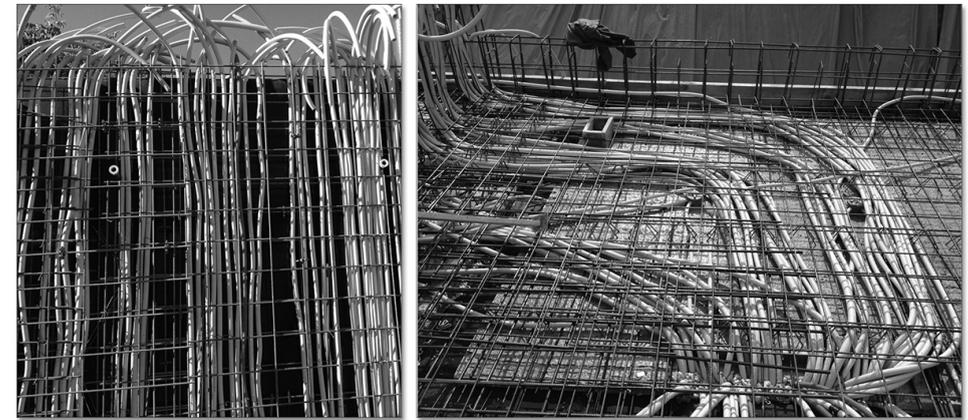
Leerrohre in Wand (links) und Betondecke (rechts)
